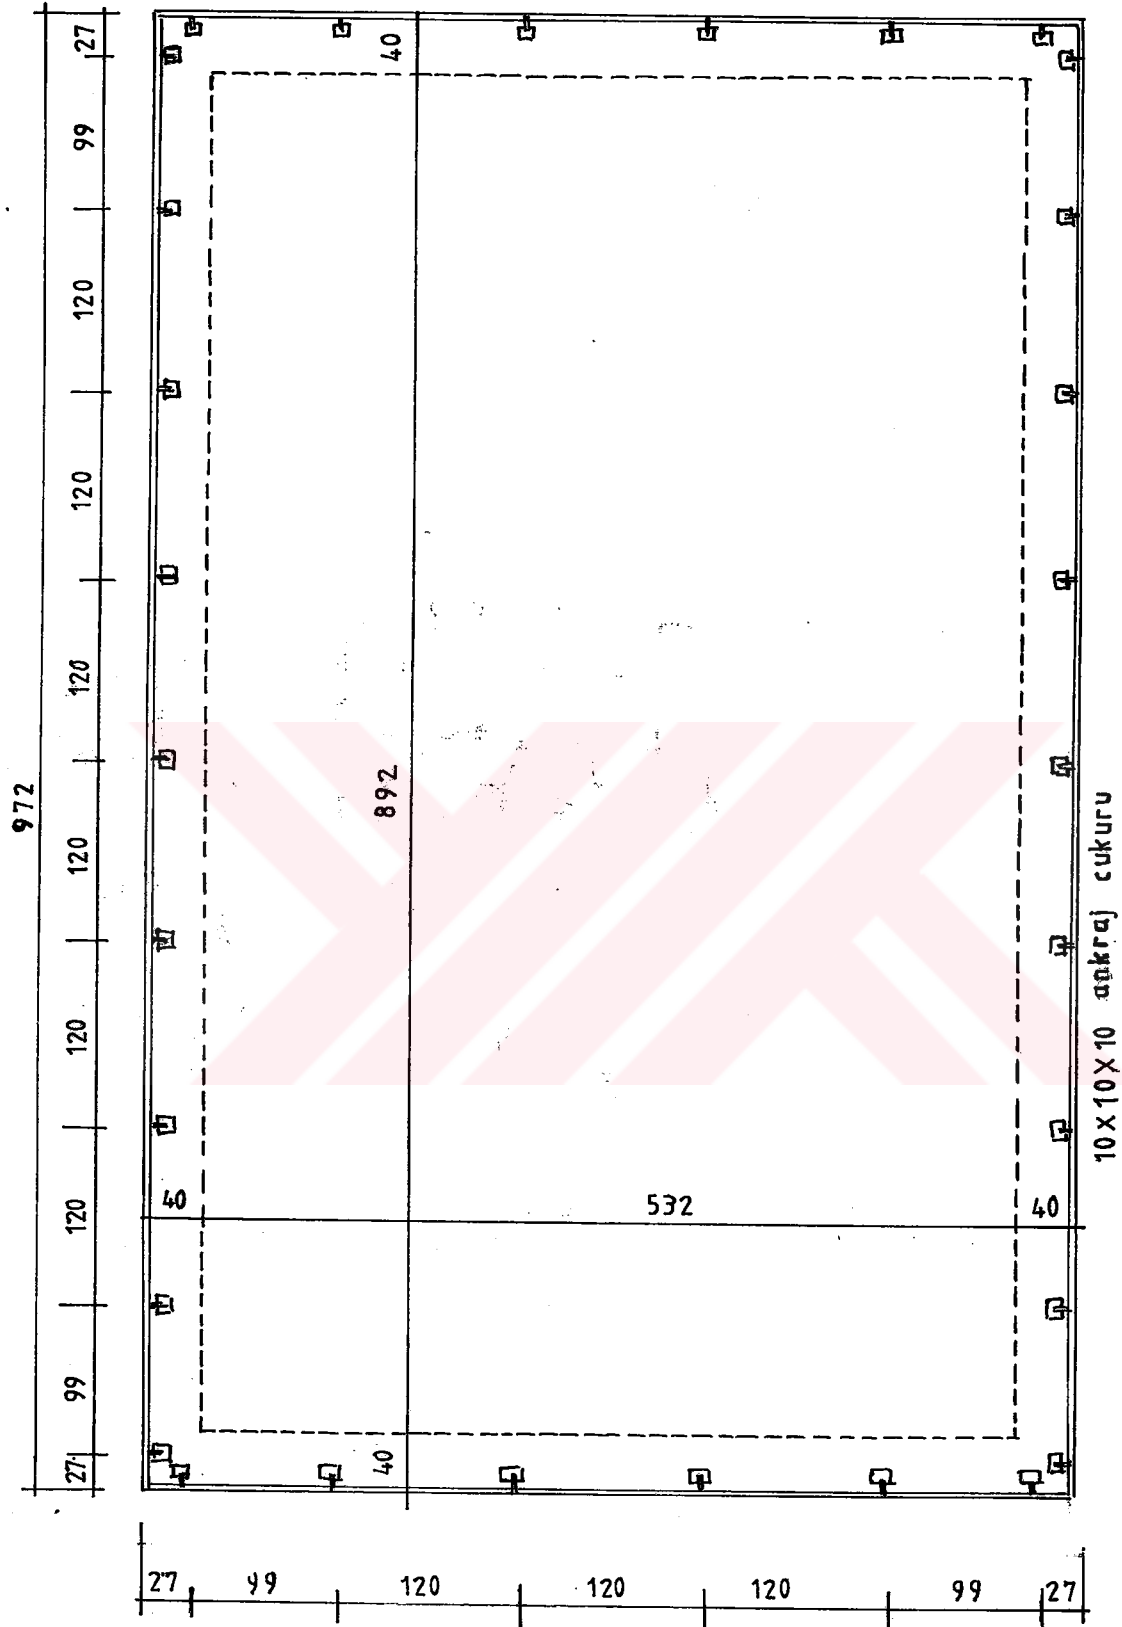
Hafif Beton Pano Çatı ve Temel Birleşim Detayı (2)
